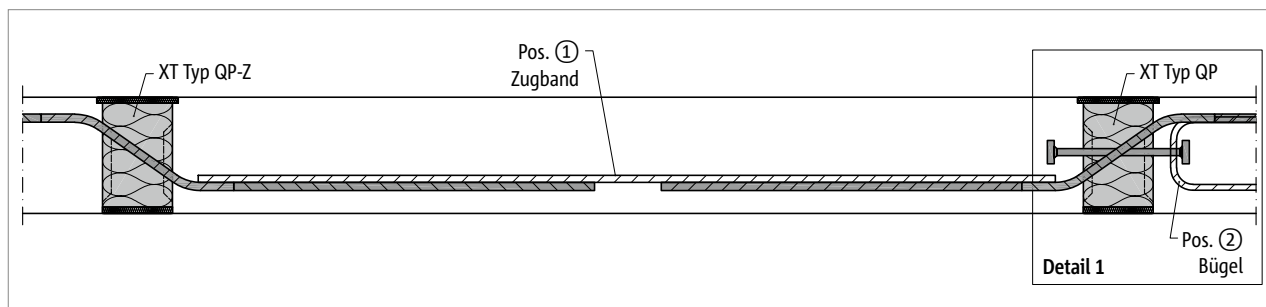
Schöck Isokorb® XT Typ QP-Z, QP: Schnitt A-A; Bewehrungsanschluss Zugband
